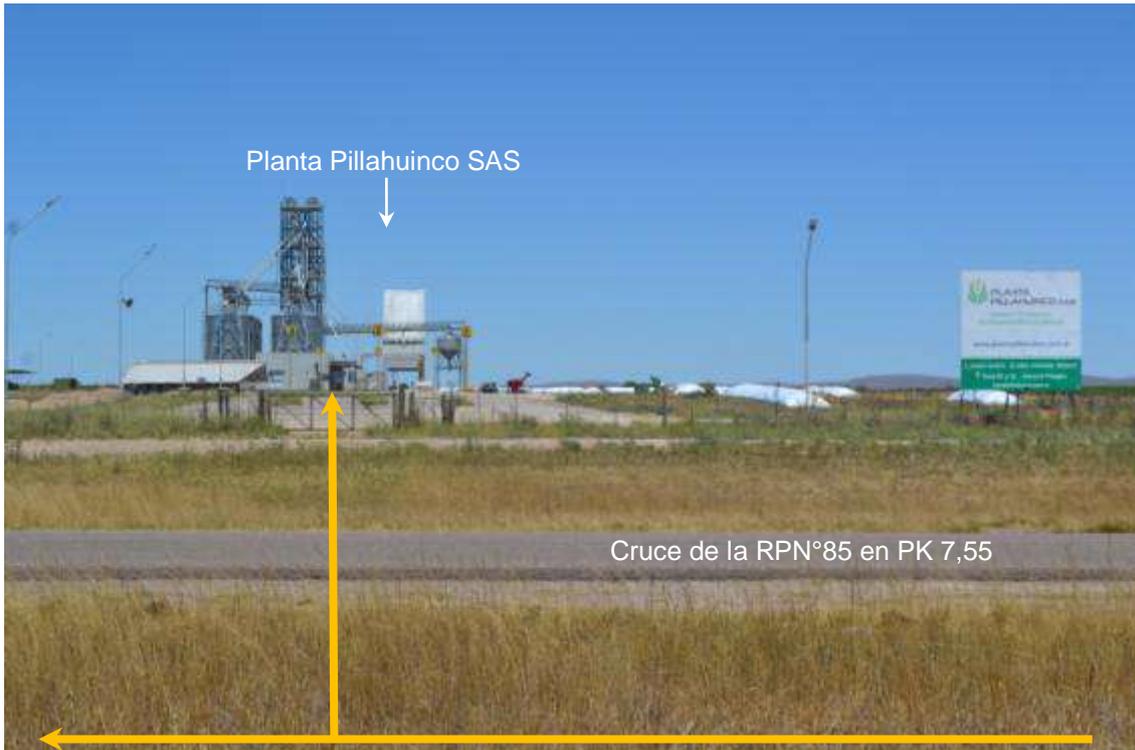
PK 7,55. Vista con mayor detalle de la infraestructura de la Planta Pillahuinco, donde se observa cartelería de identificación, tranquera de acceso, alambrado y alumbrado perimetral, planta de silos.
